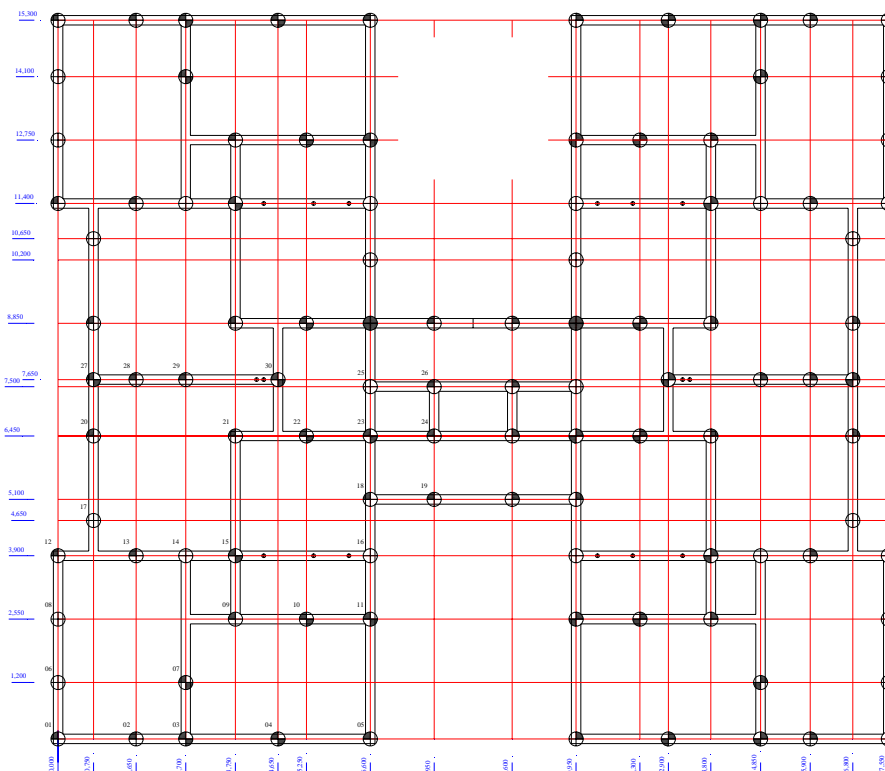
Planta esquemática da Fundação por estacas e vigas baldrame.
